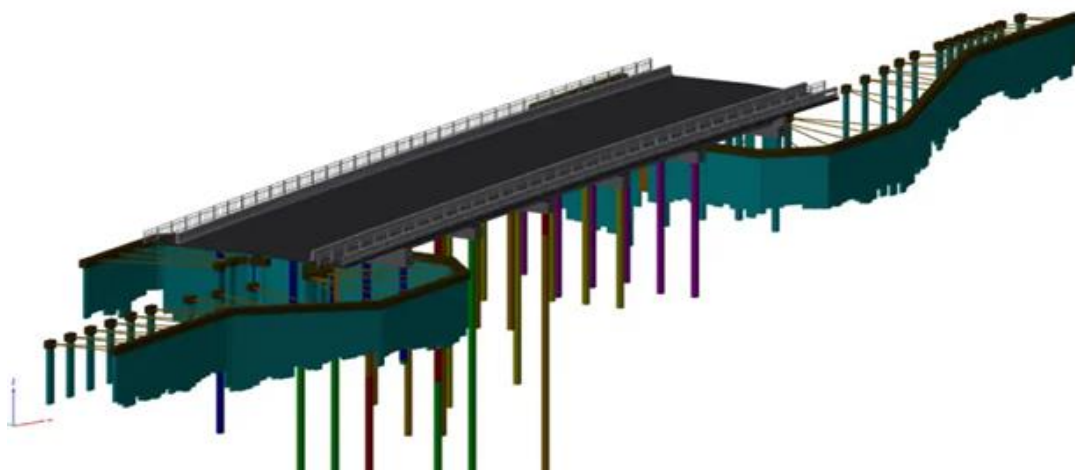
Representación 3D del proyecto AS-built del puente sobre el río Halls. (Engineering Management Institute)
